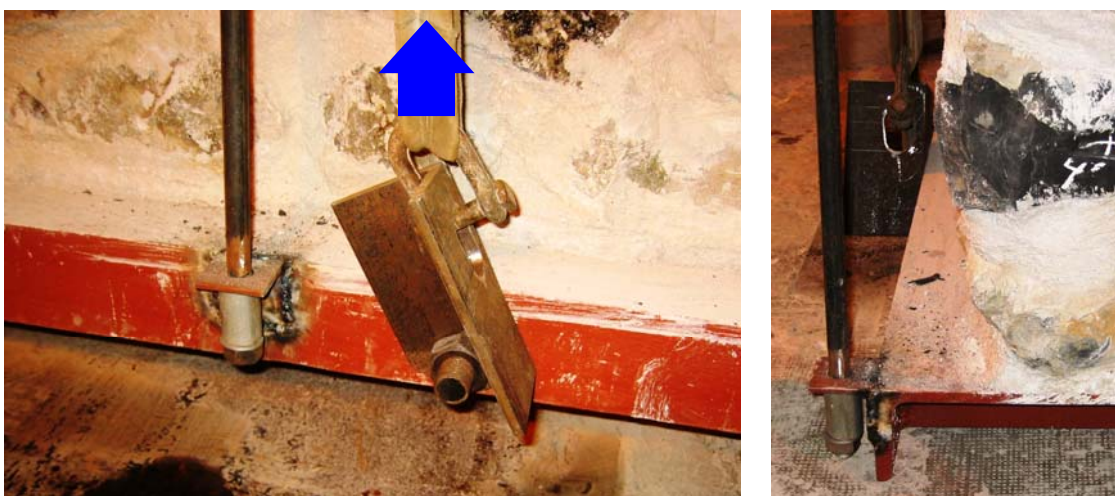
Detalle de uno de los cuatro elementos de izado dispuestos sobre el UPN rigidizado sobre el que se construyó el muro de mampostería.
